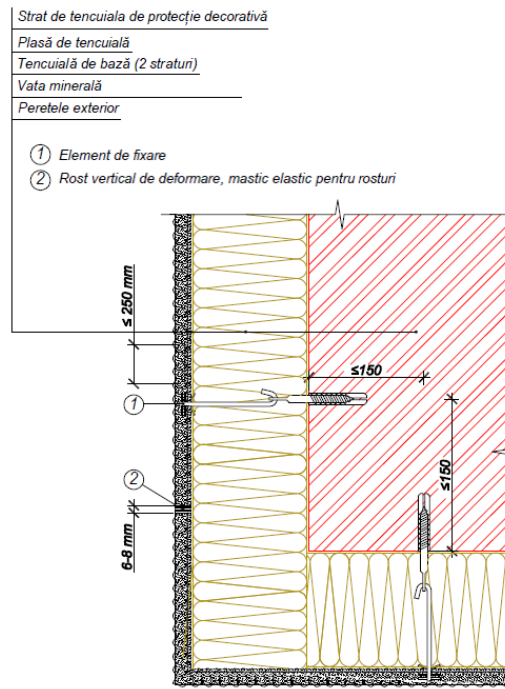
Izolarea termică a colțului extern și amenajarea rostului vertical de deformare. Profil orizontal
